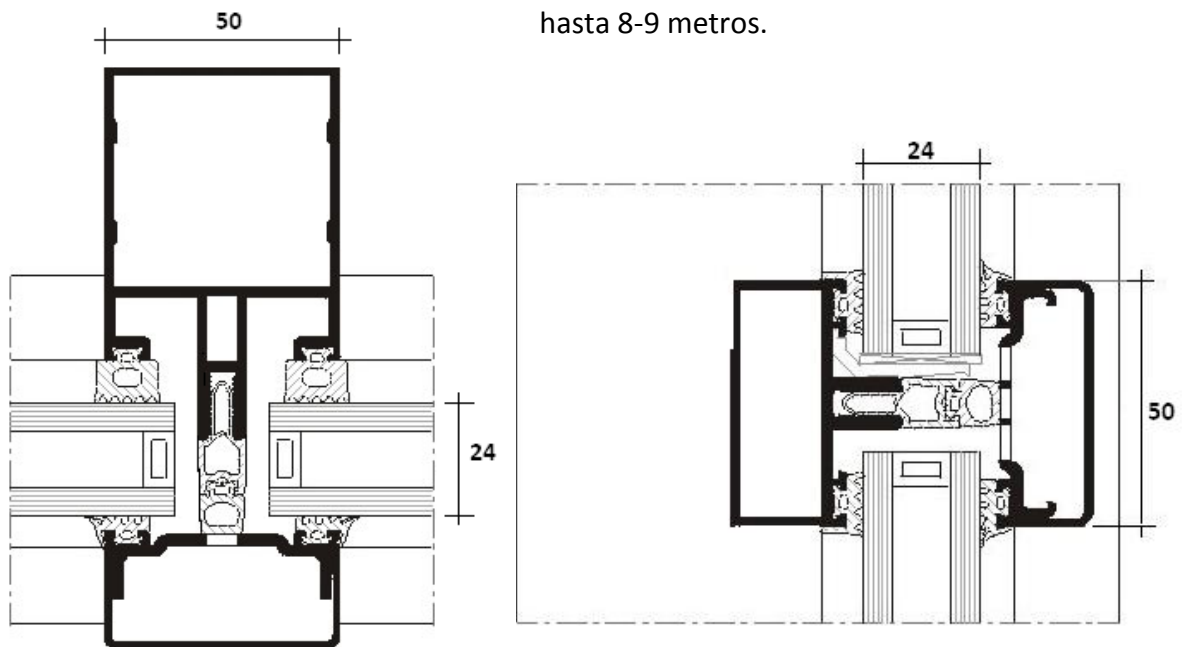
Detalle en sección horizontal (izquierda) y sección vertical (derecha) de un muro cortina modular con perfilería vista al exterior.
